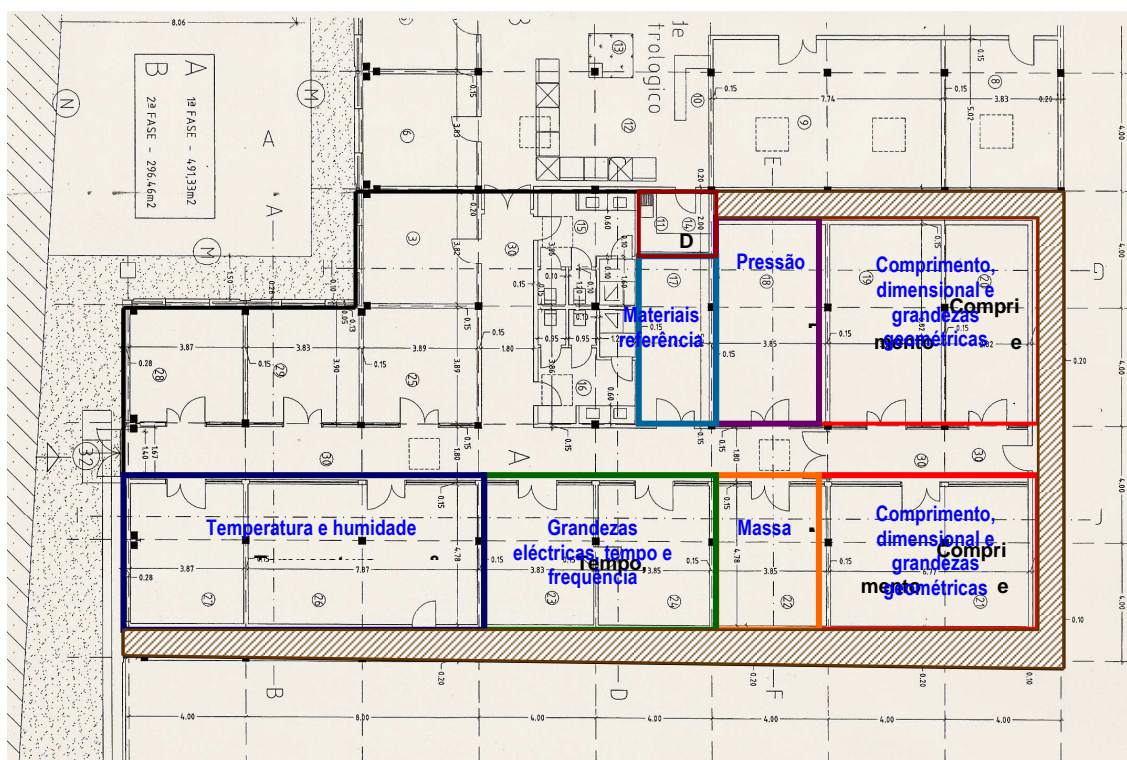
Planta das instalações parciais do LCAM/LNEC concluídas em 2007
